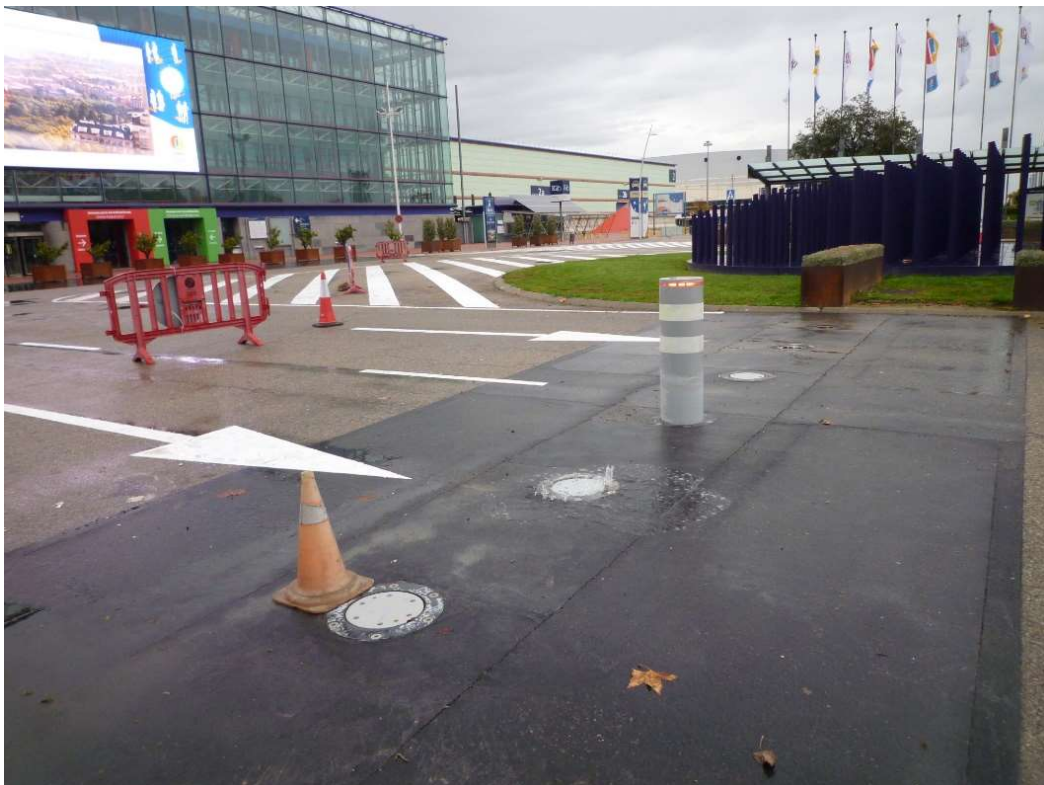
Salida de agua durante la bajada de la pizona, acceso K1
